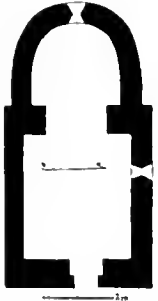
Santa Maria de Vida. Plan. Escala 1/200
